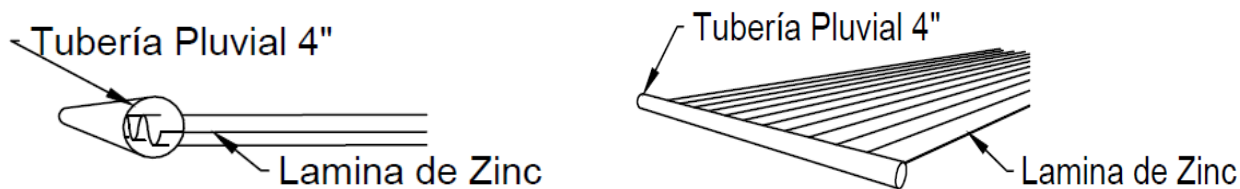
Detalle instalación tubería pluvial 4" en lámina de zinc.
